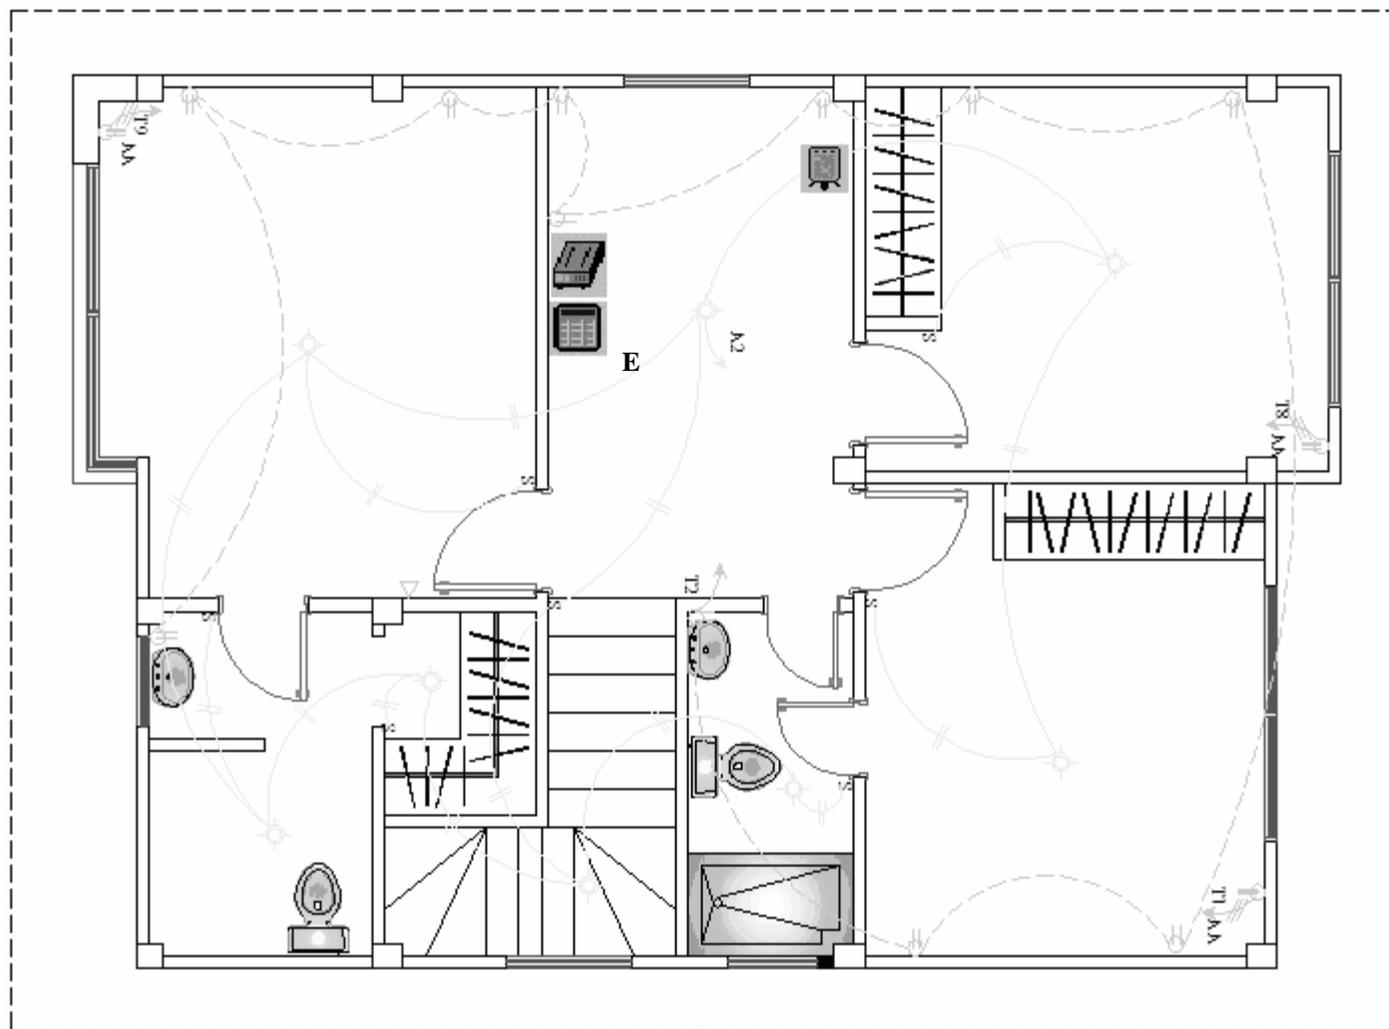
Sistema de Acceso Remoto, Planta Alta, Plano Eléctrico.
